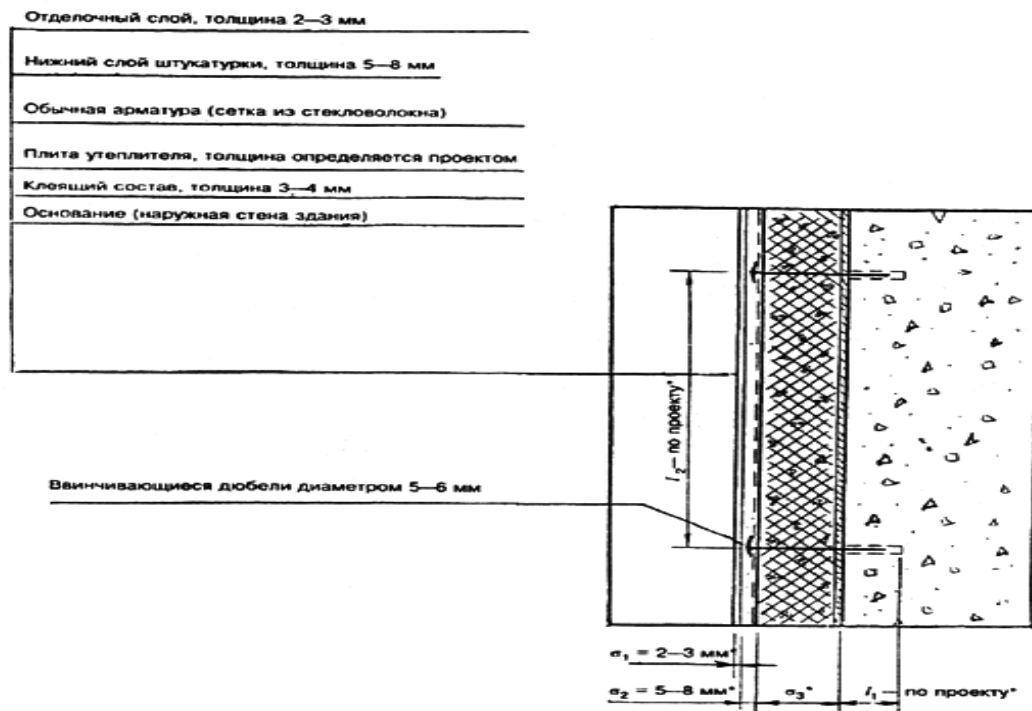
Фрагмент зовнішньої теплоізоляції будівлі з тонкою штукатуркою по утеплювачу
